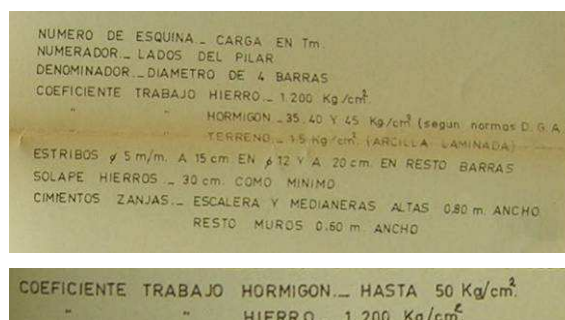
Leyenda Plano de estructura Edificio ficha 219C.006, 1971
